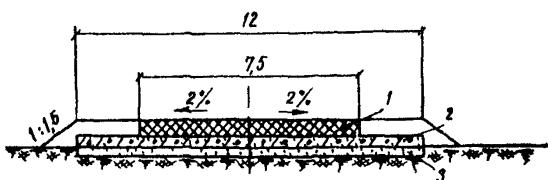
Конструкция земляного полотна с распределяющей плитой:
